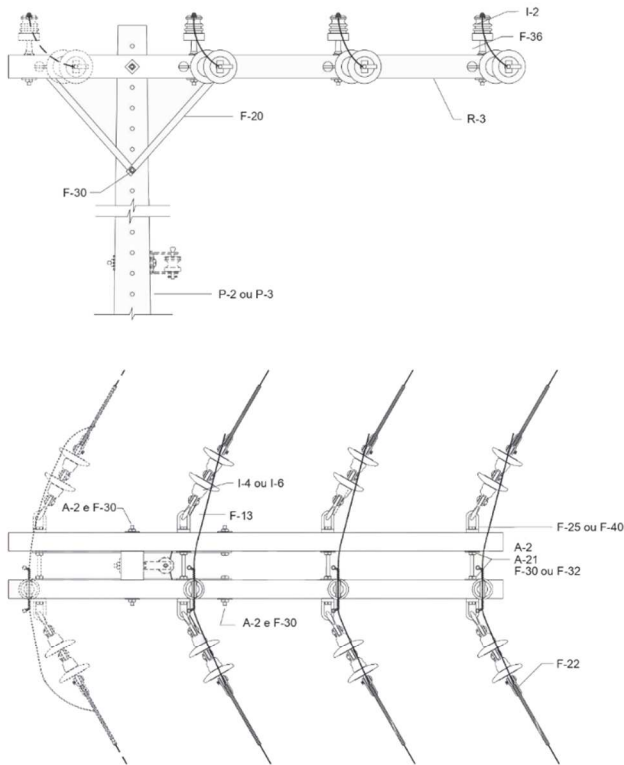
Primário – Estrutura M4 – Poste de concreto de seção circular – Cruzeta de 2 400 mm
